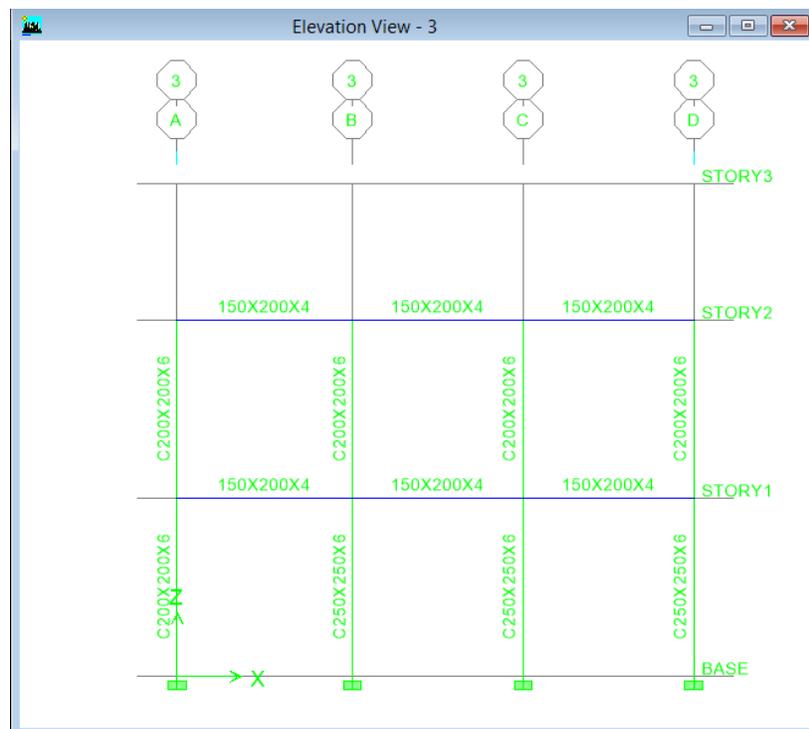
; Secciones Asignadas EJE 3 Del diseño estructural metálico
